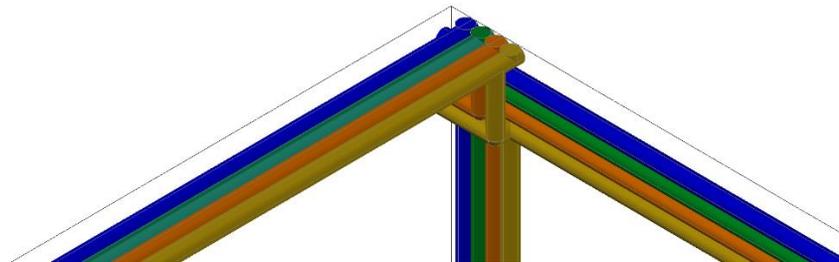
Conjunto final de tubos adicionados na cor amarela
